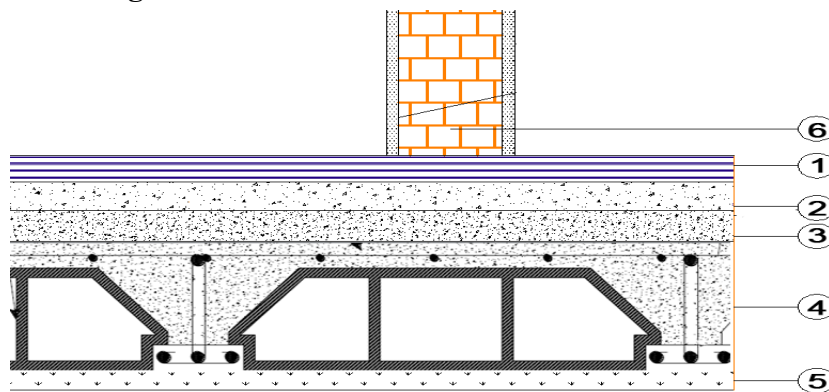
Coupe verticale d'un plancher d'étage courant
